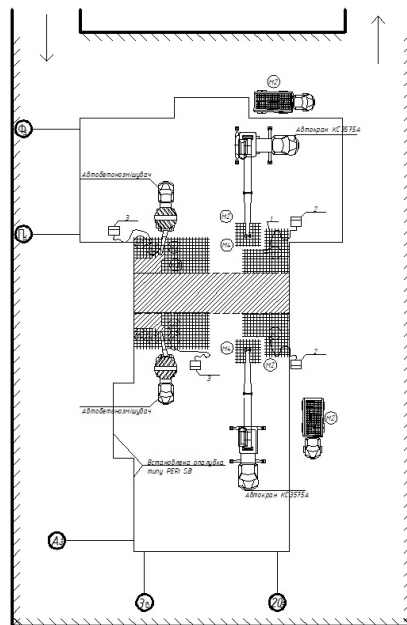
Схема бетонування фундаментної плити двома захватками
